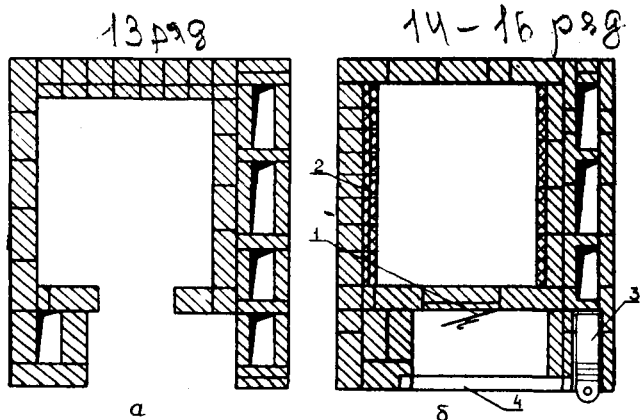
Кладка печи № 2 с 13-го по 16-й ряд: а — 13-й ряд; б — 14—16-й ряды; 1 — дверка пекарской камеры; 2 — пята для сводов; 3 — задвижка канала от варочной плиты; 4 — уголок над загнеткой
